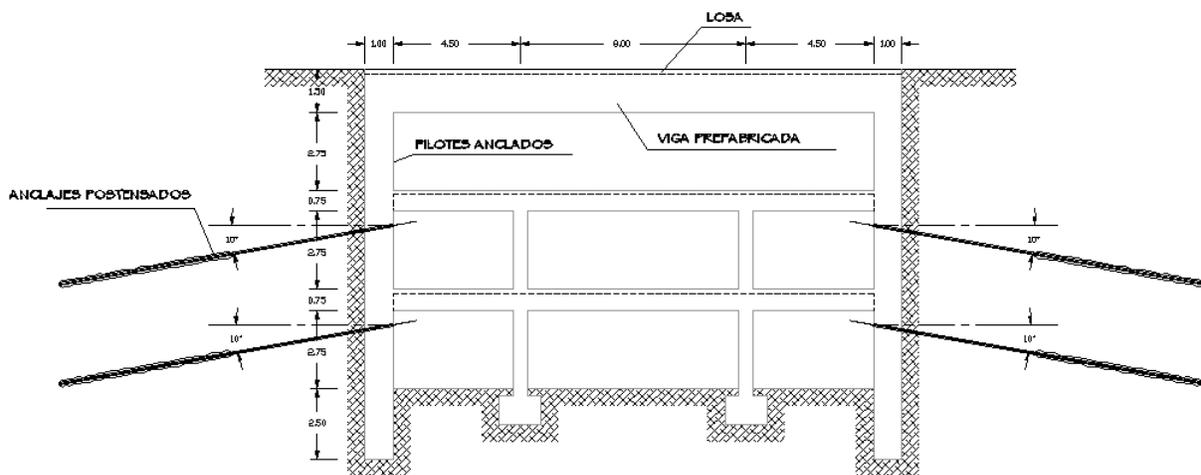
Estacionamiento Subterráneo - Esquema de solución mediante muros de pilotes en el perímetro
